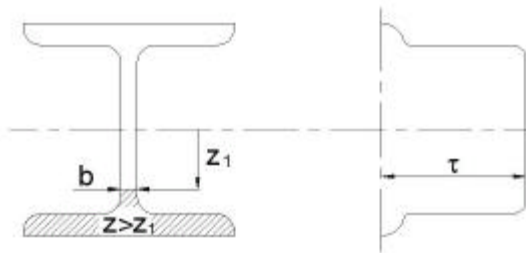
Distribución del esfuerzo de corte en un viga I.
